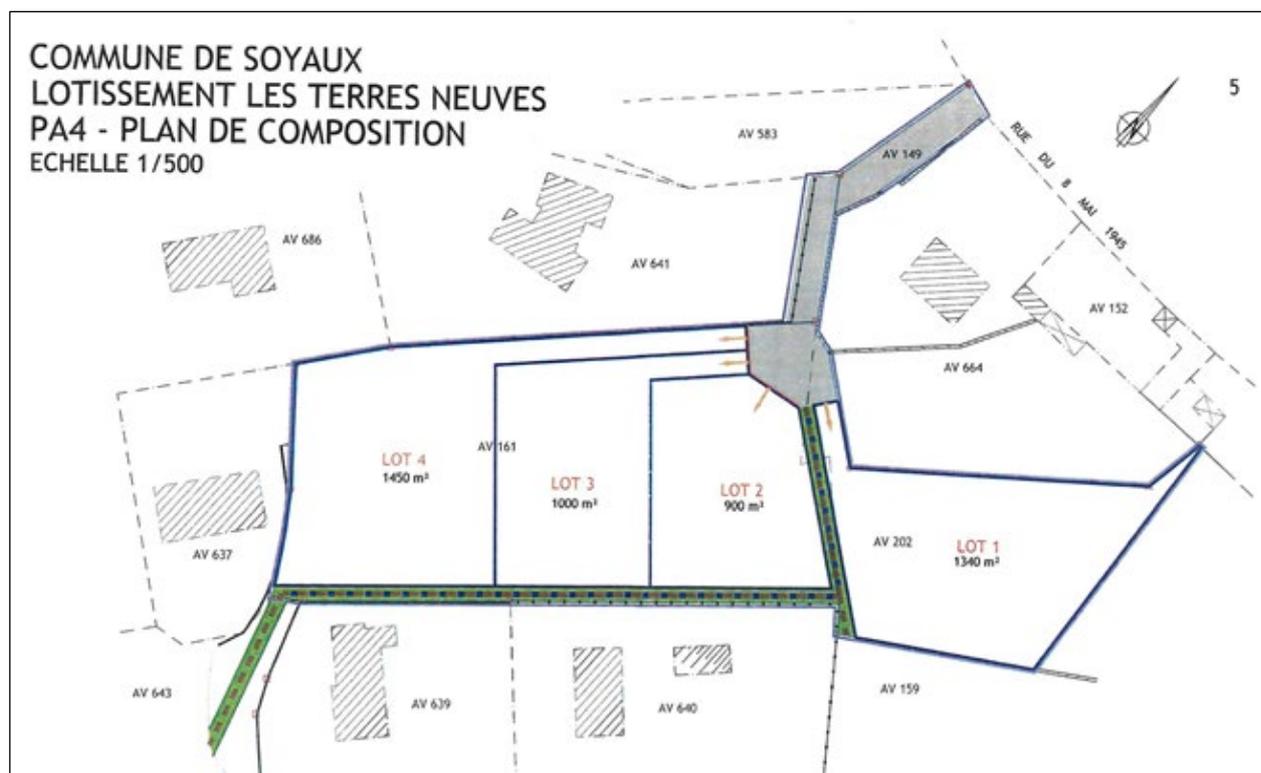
Extrait du plan cadastral du lotissement (source : géomètre JP ENNUYER)
